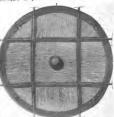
Pianta d'una pinttaforma girevole circolare con binsrii rettangolari.
